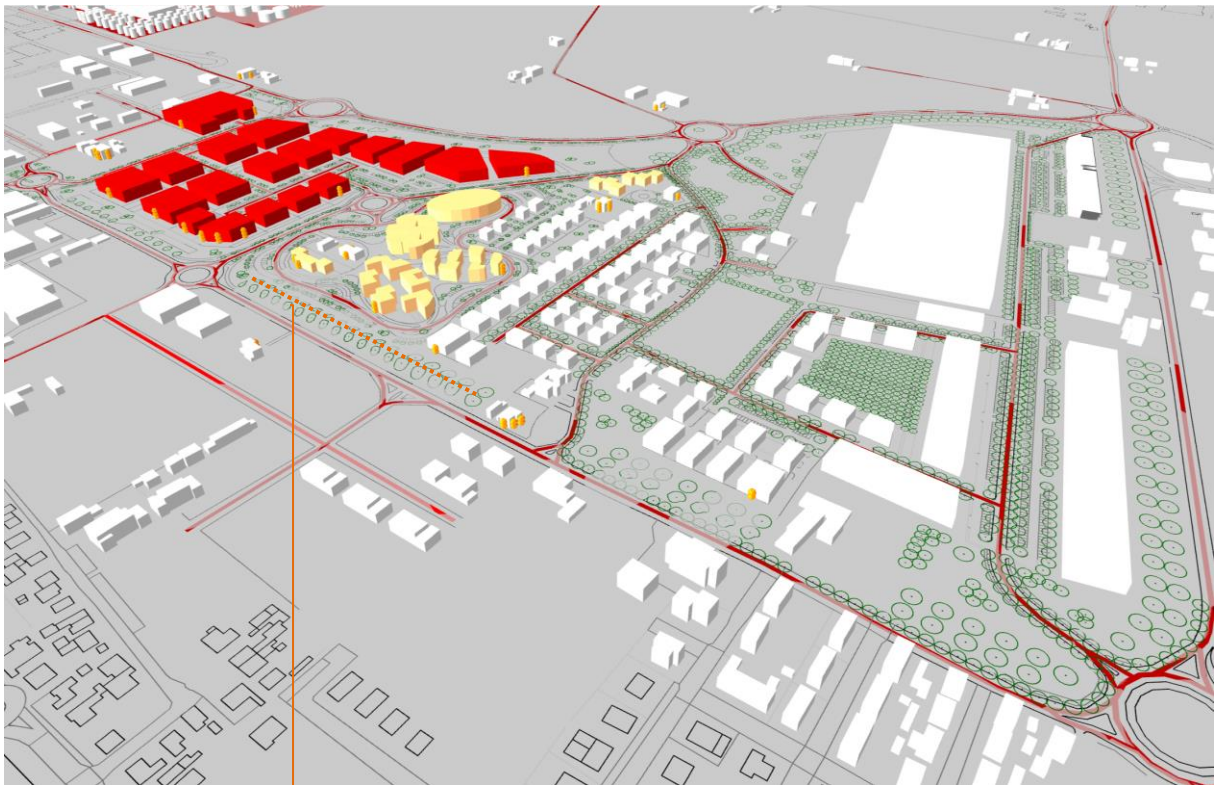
Rappresentazione planimetrica dell'intero ambito nello scenario finale di progetto.
